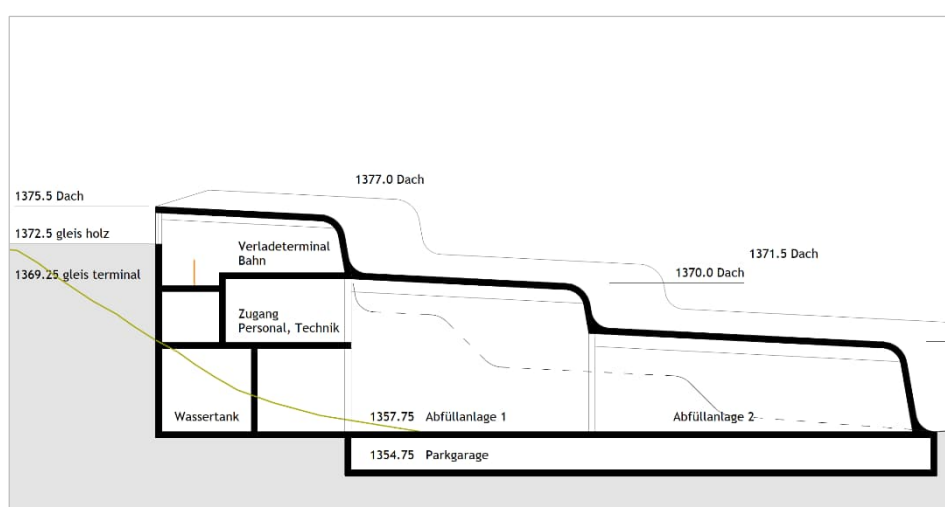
Schnitt B-B Vorprojekt, Stand: 03.03.2010
